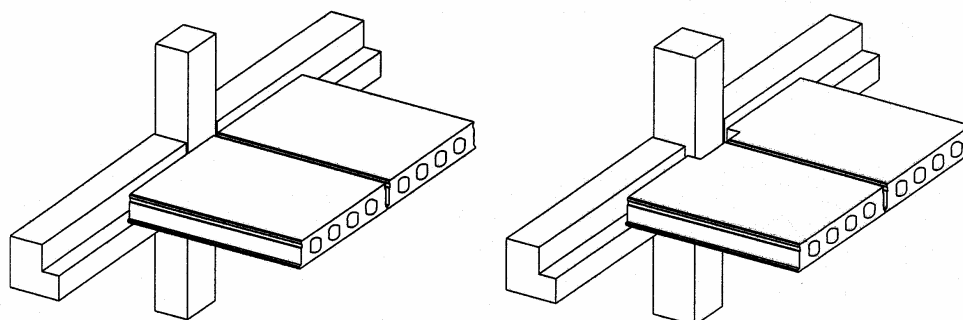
Interseção entre viga e pilar no nível dos pavimentos
